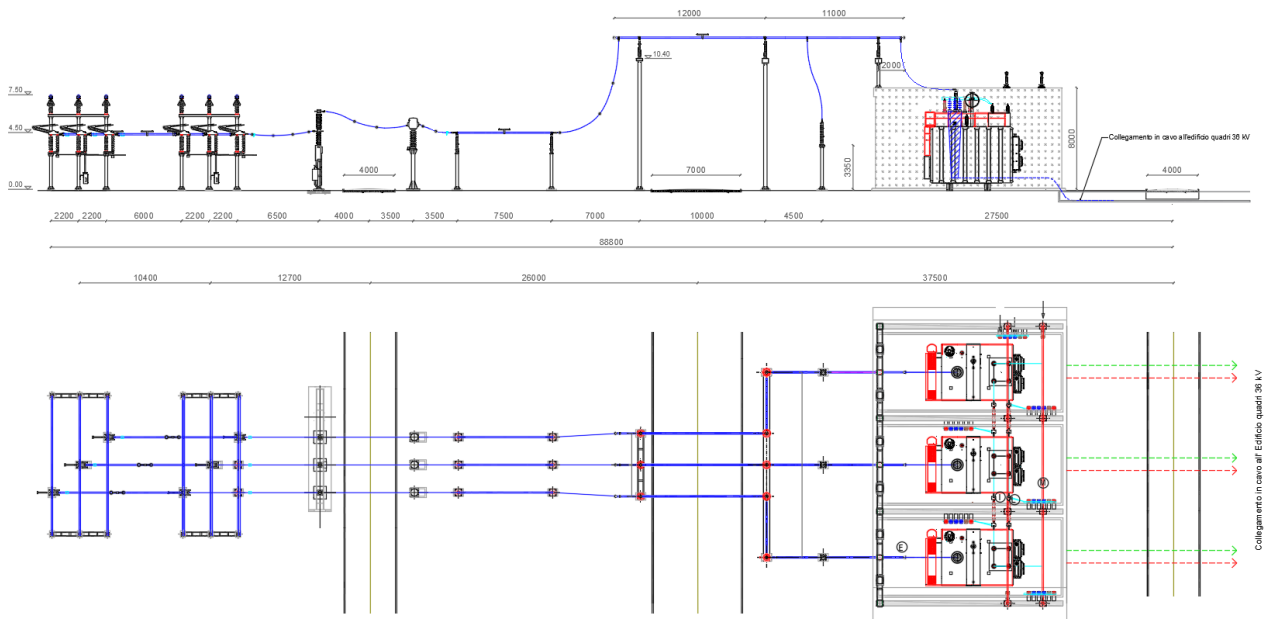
Pianta e sezione montante TR 150/36 kV da 250 MVA
